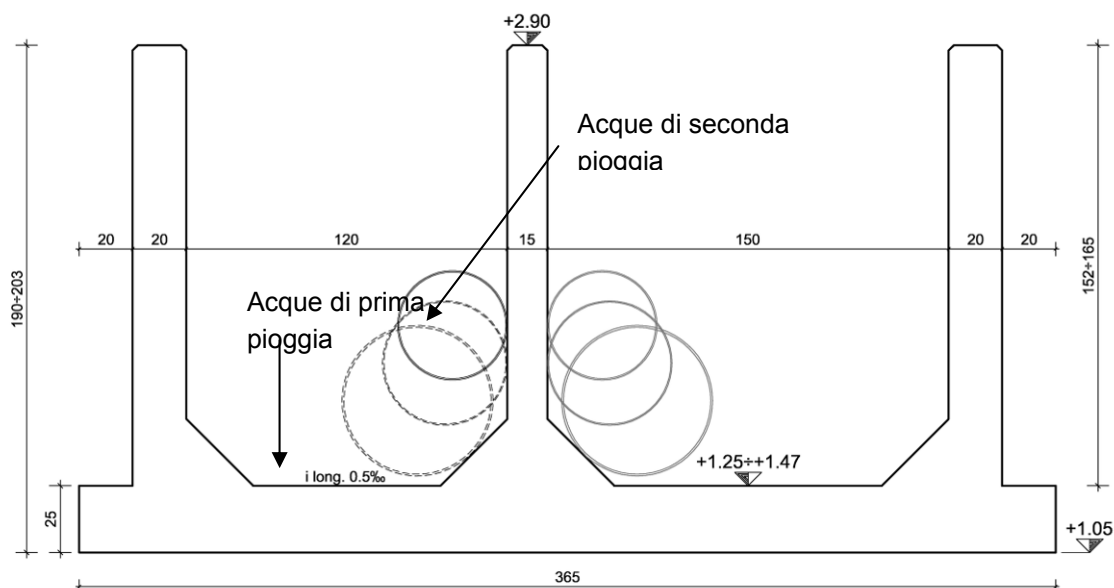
Sezione del canale di raccolta acque meteoriche nel tratto centrale di delimitazione fra i due lotti; il dispositivo di separazione delle prime e seconde piogge illustrato nella figura (a sinistra in tratto nero perché compreso in questo progetto e in grigio nella parte a destra poiché afferente al completamento della MISP nel lotto 2) ha interasse di 50 m; le tubazioni della seconda pioggia crescono in diametro da sud verso nord e hanno pendenza dell'1.5‰.
